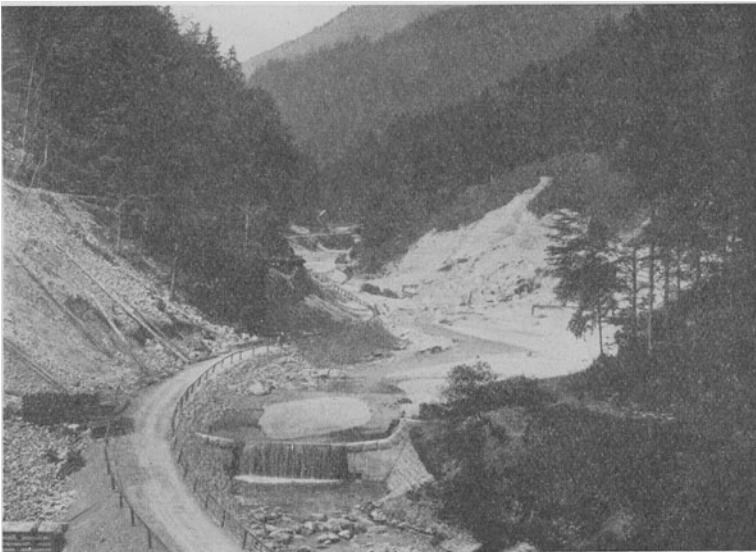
Langbathbach, Salzkammergut, verbaute Bachstrecke vor Beruhigung der Bruchflächen (1901).
